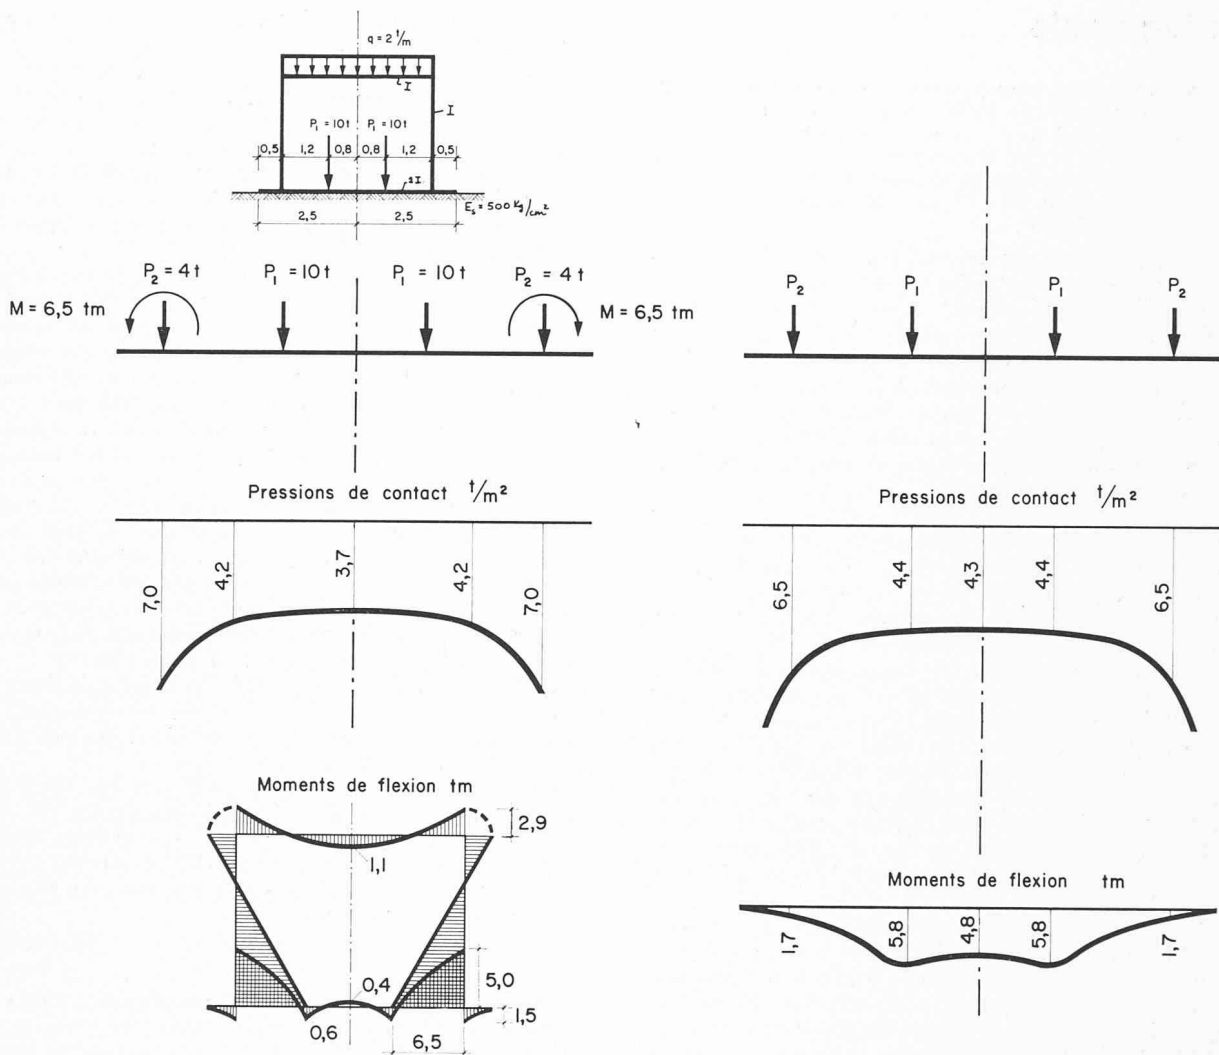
Calcul d'un cadre appuyé sur le sol.
